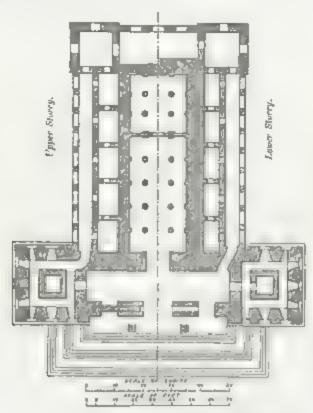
Grundriss des herodianischen Tempeli. (Rekonstr. J. Fergusson, 1878).
